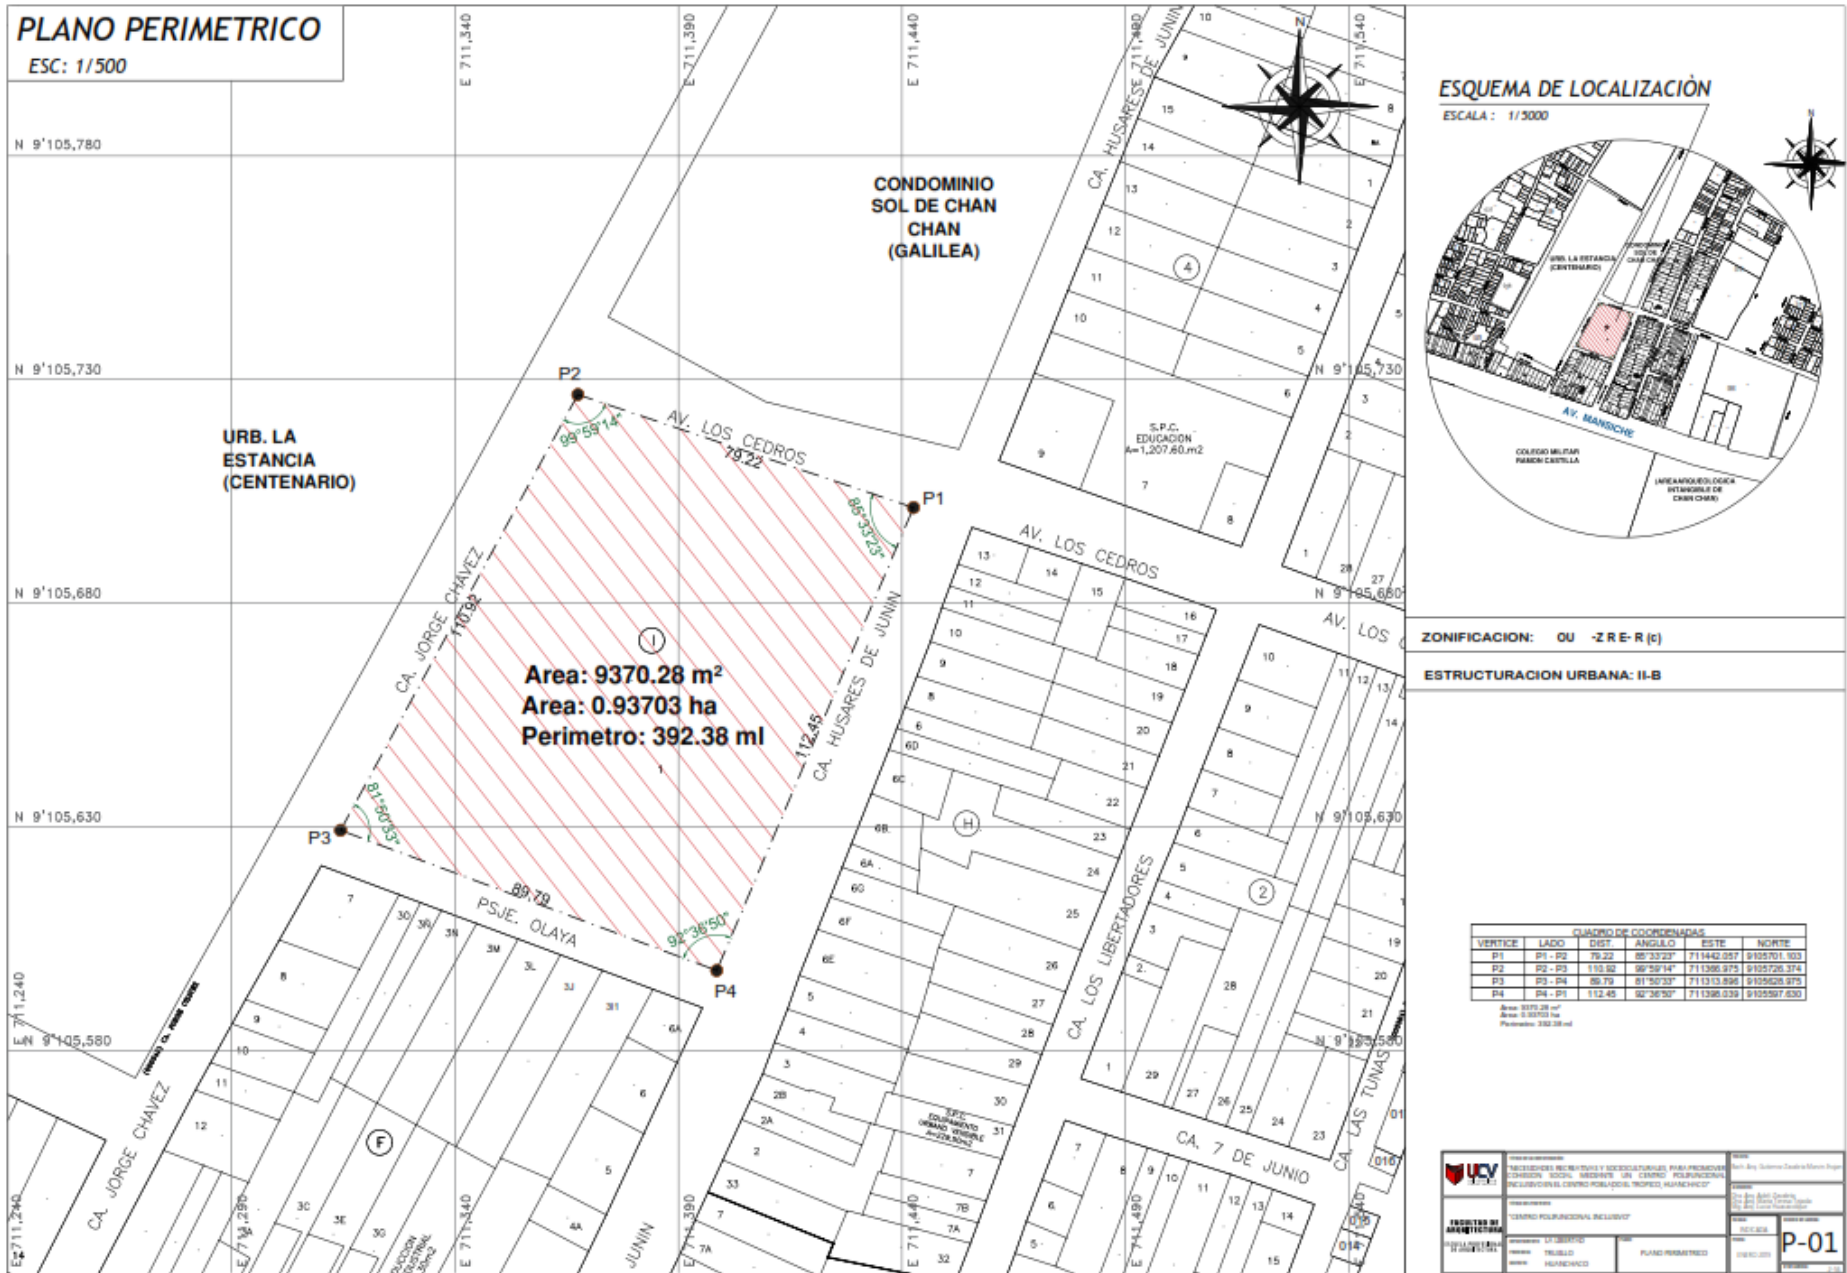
Plano Perimétrico: P-01. Fuente: Propia (2018)
